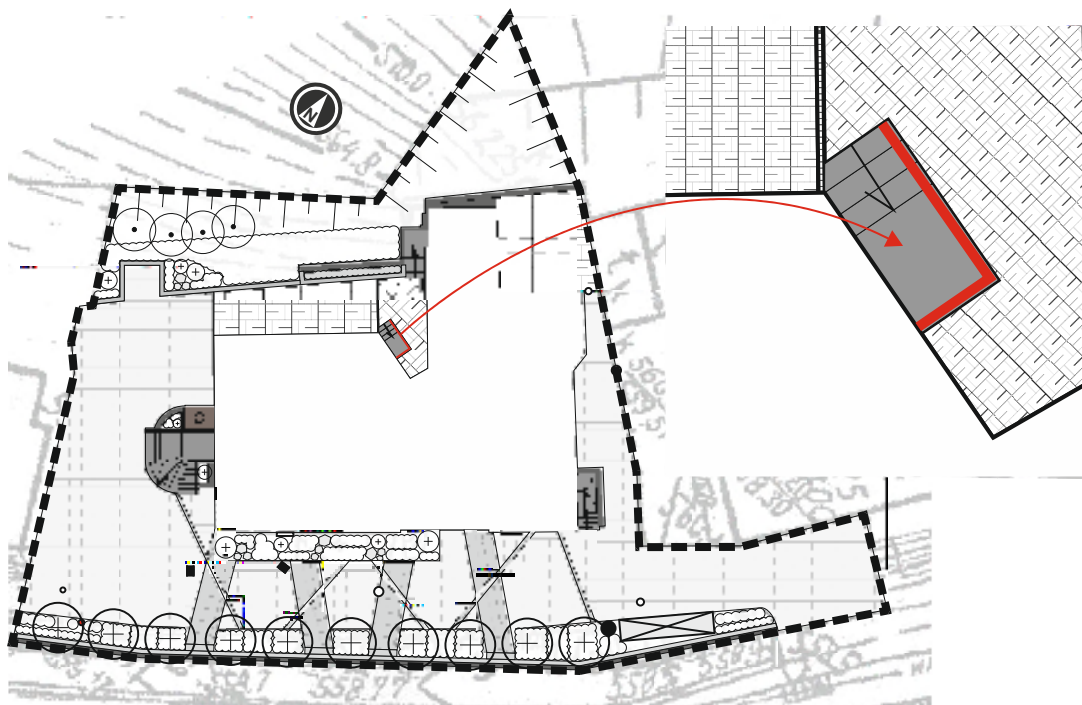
Proponowana kolorystyka płytek gresowych projektowanych okładzin schodów
